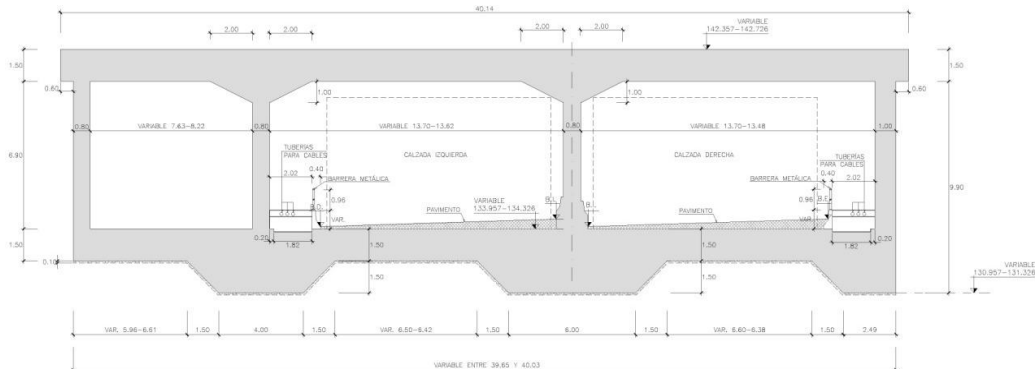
Sección transversal del túnel bajo el Puente de Trujillo
